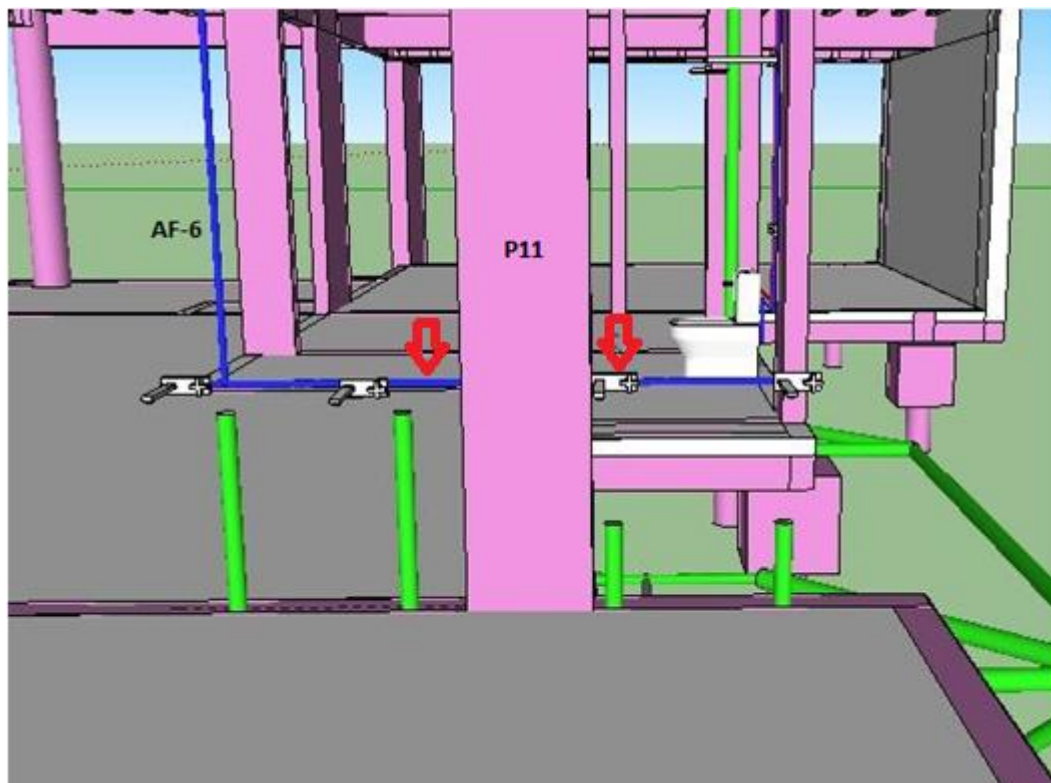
Interferências entre projeto estrutural e projeto hidrossanitário: componente térreo
